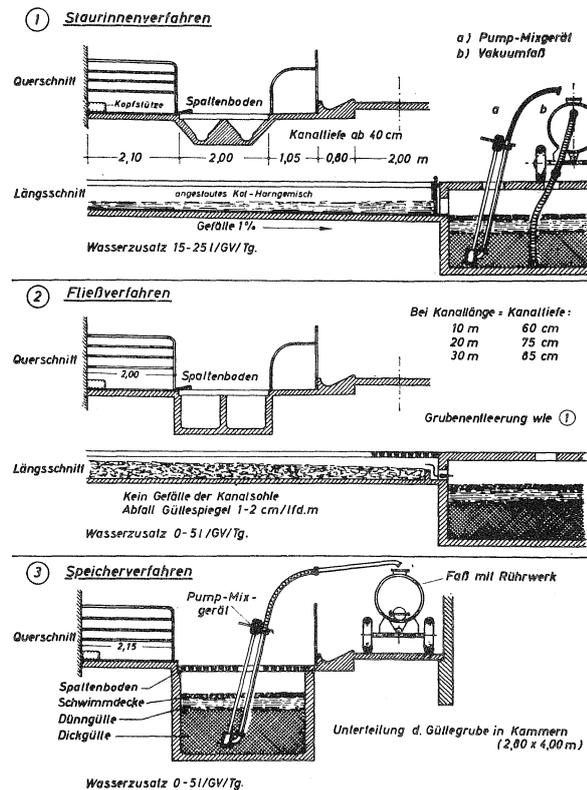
Flüssigmistverfahren für Boxenställe mit Spaltenbodenaufläufen
